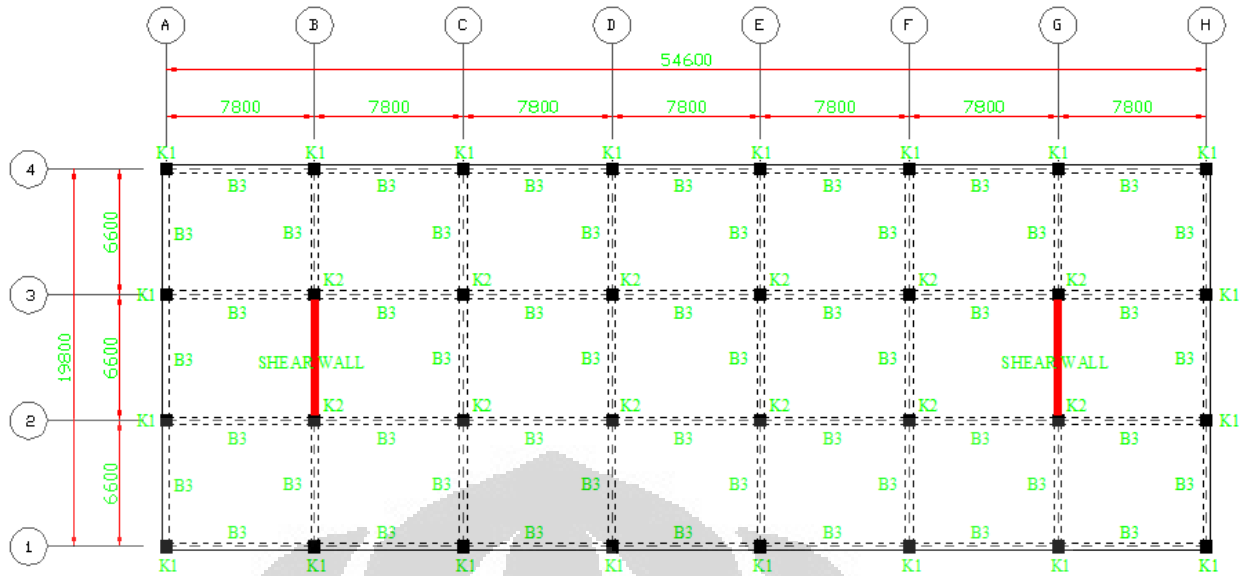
Denah Struktur Beton Lantai 1-4
